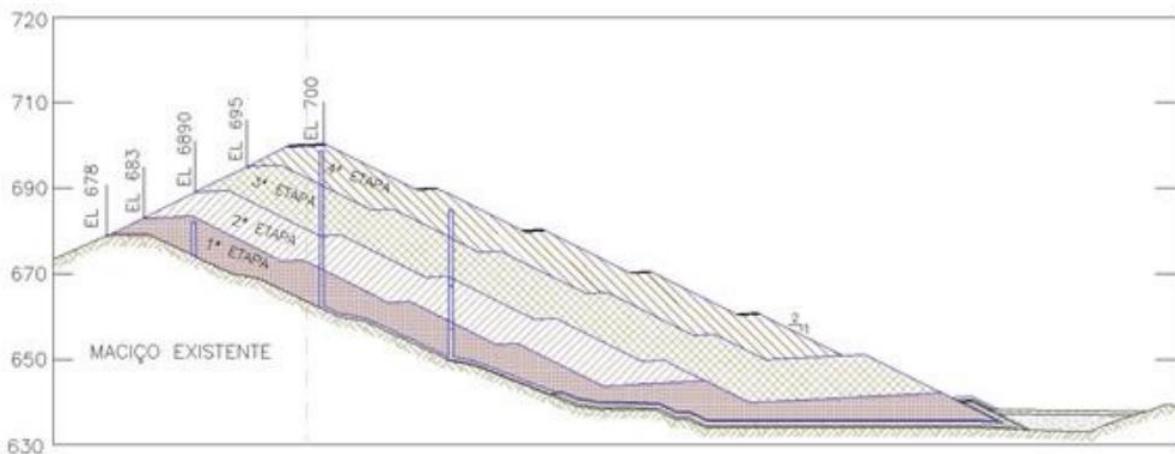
Seção típica do 1º alteamento da barragem até a elevação 700 metros (Fonte: Manual de Operação da Barragem, 2019)
